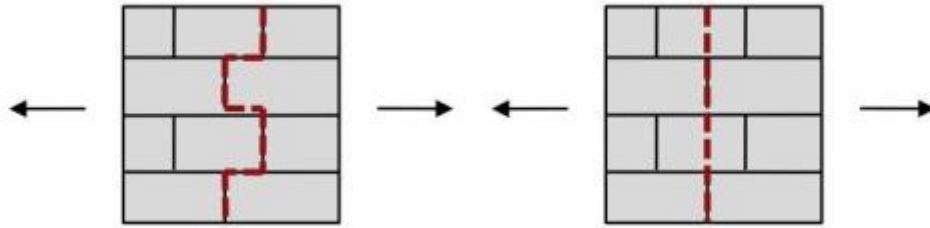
Agrietamiento de la mampostería por grietas escalonadas y verticales.
